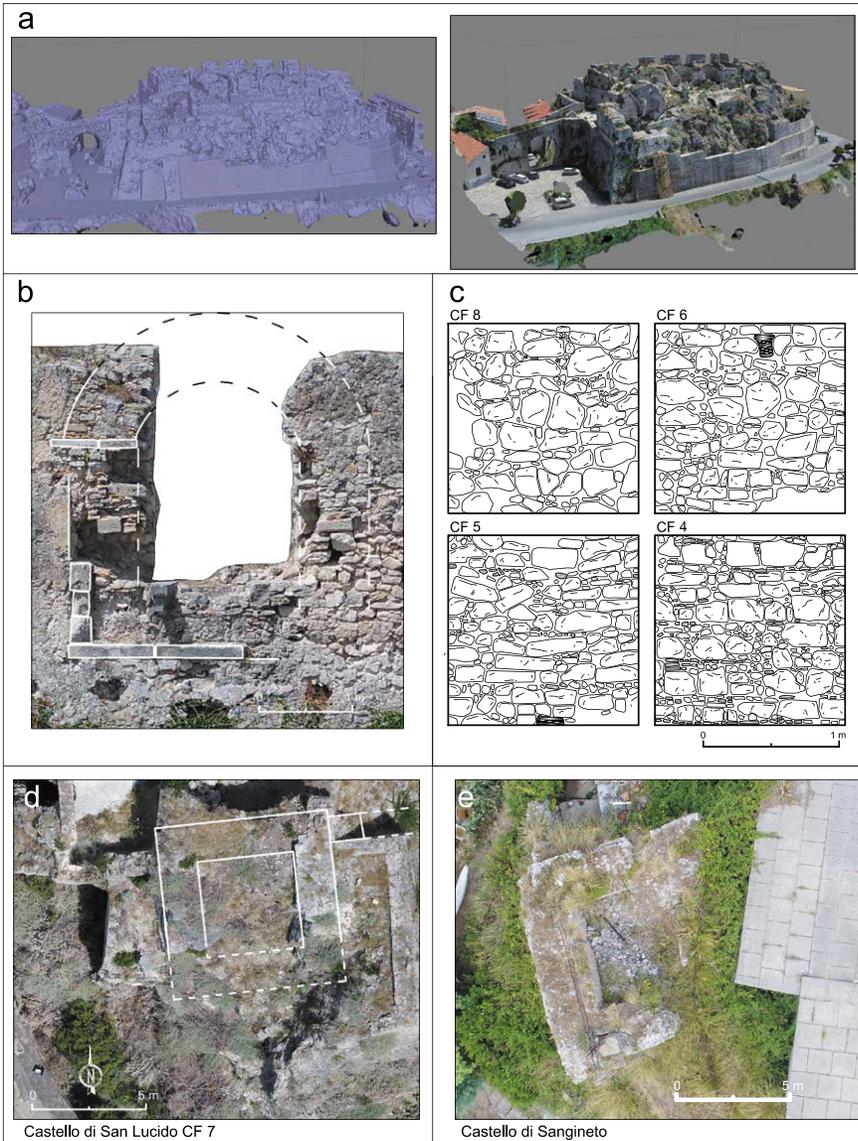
a, alcune fasi dell’elaborazione del modello tridimensionale del castello di San Lucido; b, dettaglio dell’analisi degli elevati relativo a una finestra presente sul prospetto ovest; c, apparecchiature murarie presenti nei corpi di fabbrica del castello; d, veduta nadirale del torrione quadrangolare CF7; e, veduta nadirale del torrione quadrangolare del castello di Sangineto (CS).
